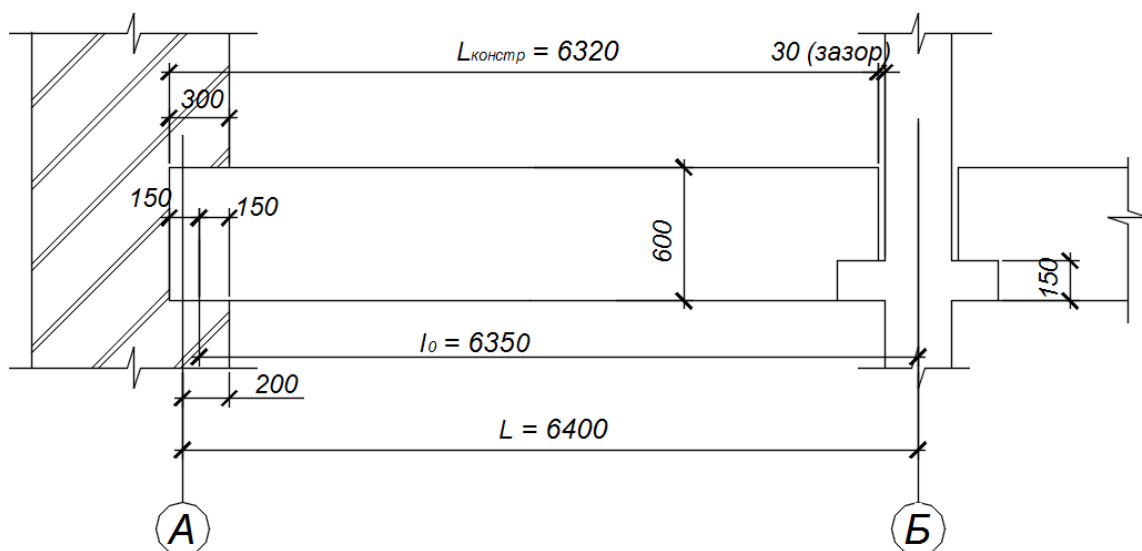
До визначення розрахункового прогону ригеля цивільної будівлі
